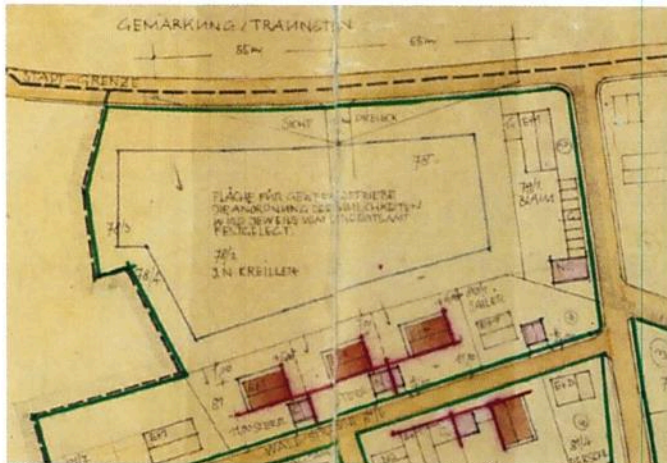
Auszug Bebauungsplan Oberhaid, Quelle: Stadt Traunstein
